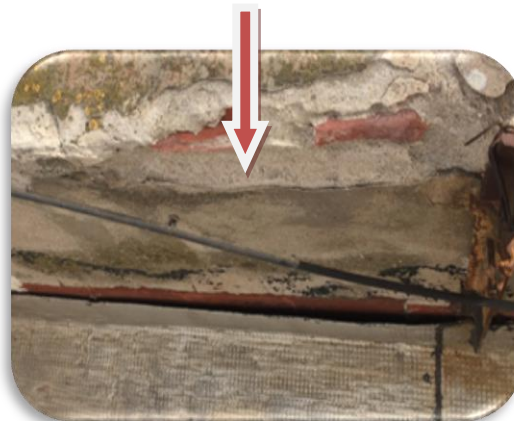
35 Détérioration de complexe d'étanchéité
